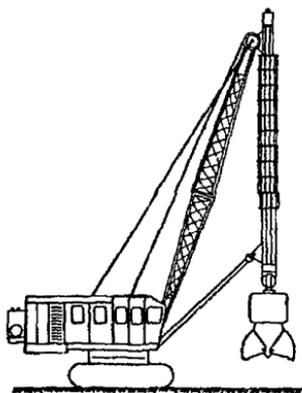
Штанговый грейфер конструкции СКБ Главмос-
